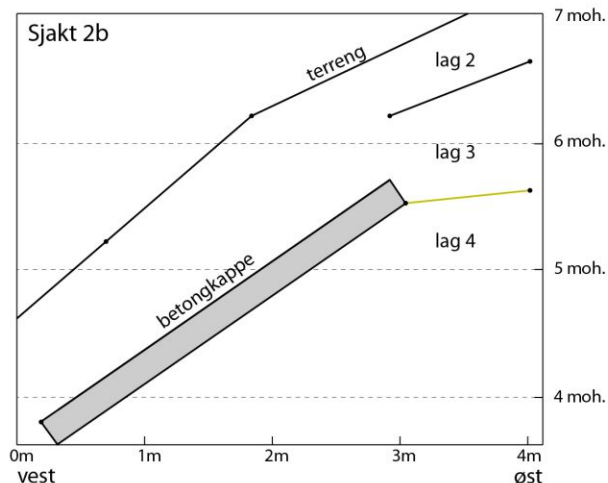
Rekonstruert snitt grøft 2b. Betongkappen er en del av Loenga brokonstruksjonen. Lag 2 og 3 er moderne.
